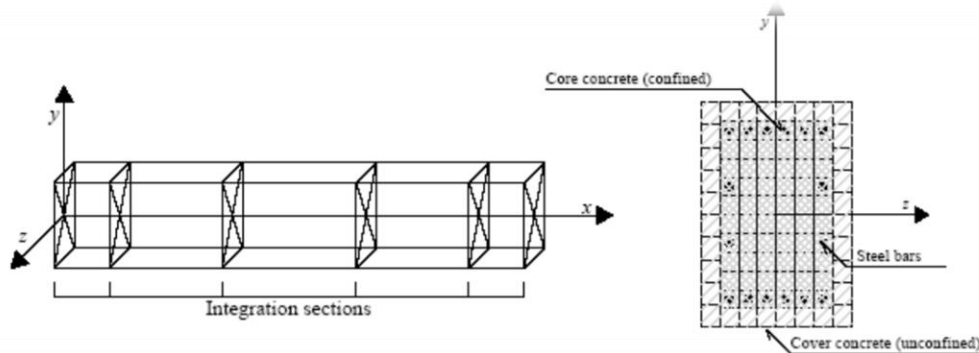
Elemento viga en el sistema de referencia local: subdivisión de la sección en fibras [13]
